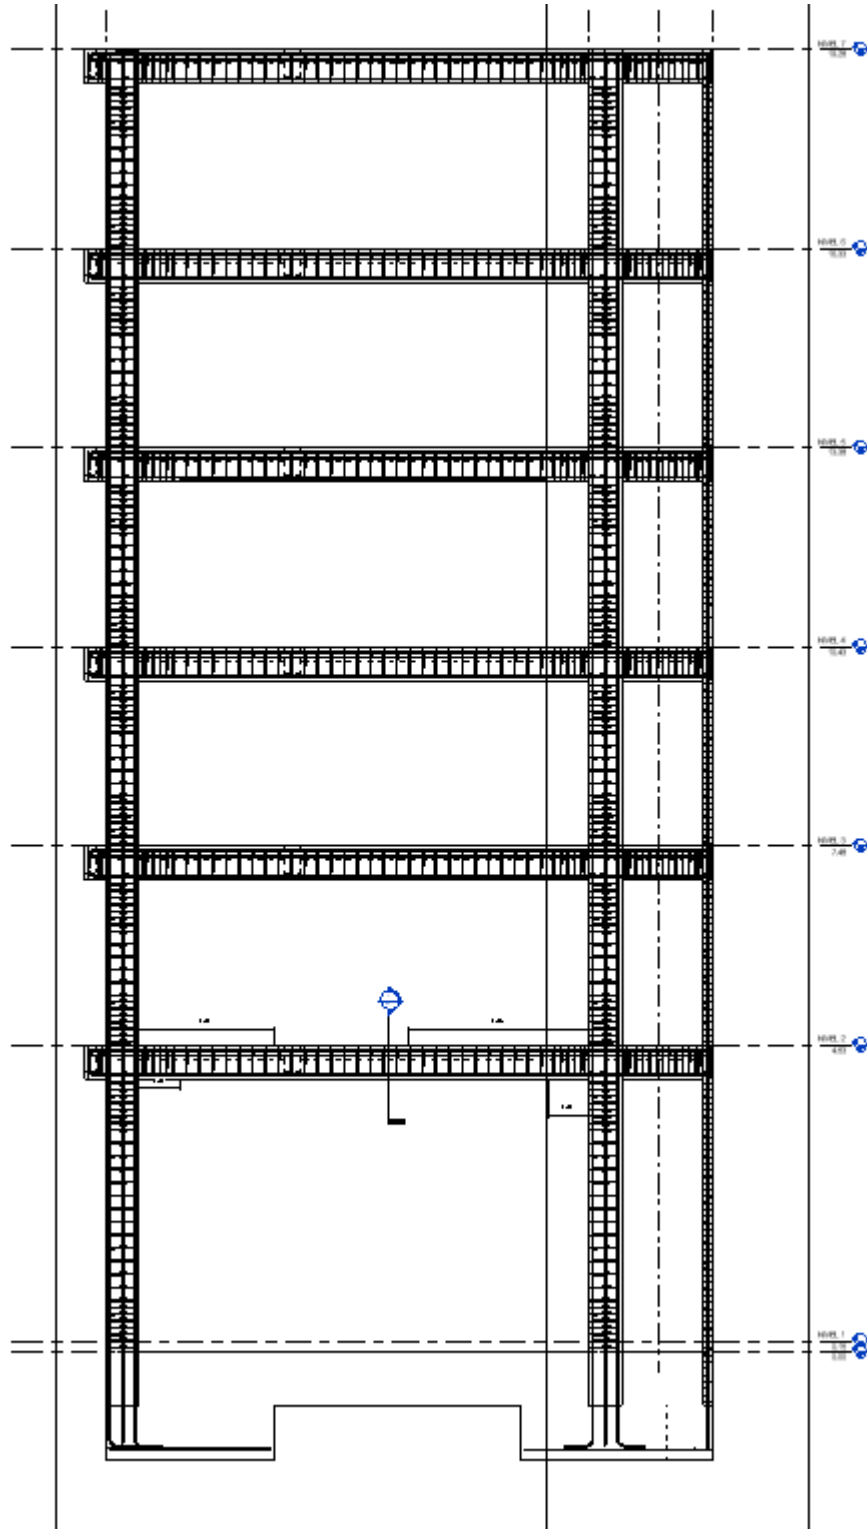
Vista Corte de distribución de acero en Viga VP-100 en Proyecto (Fuente: Elaboración Propia).
